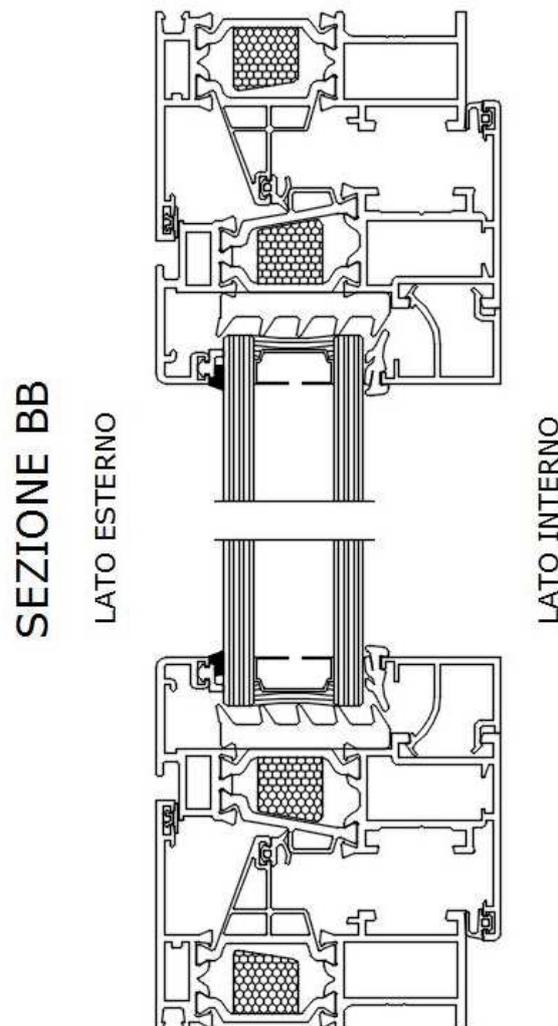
Sezione verticale BB (cfr. Fig. 1) del campione sottoposto a prova
